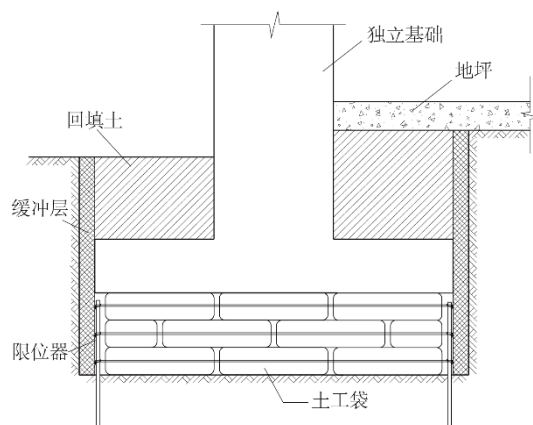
独立基础下土工袋垫层布置示意图
